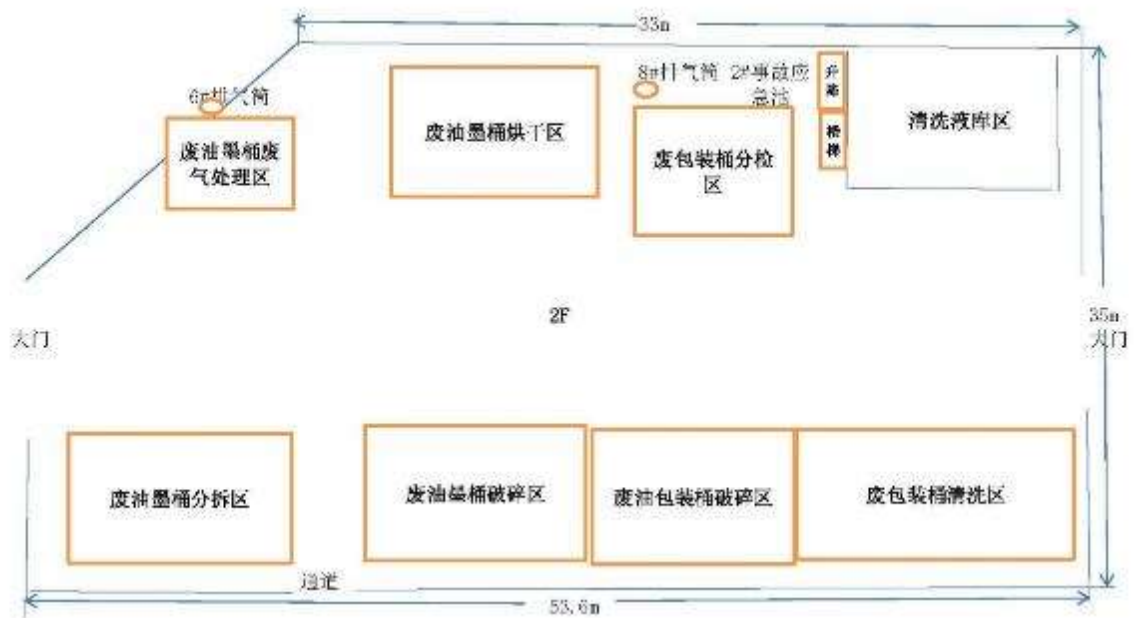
搬迁及改扩建后北厂区 3# 厂房一层平面布置图
